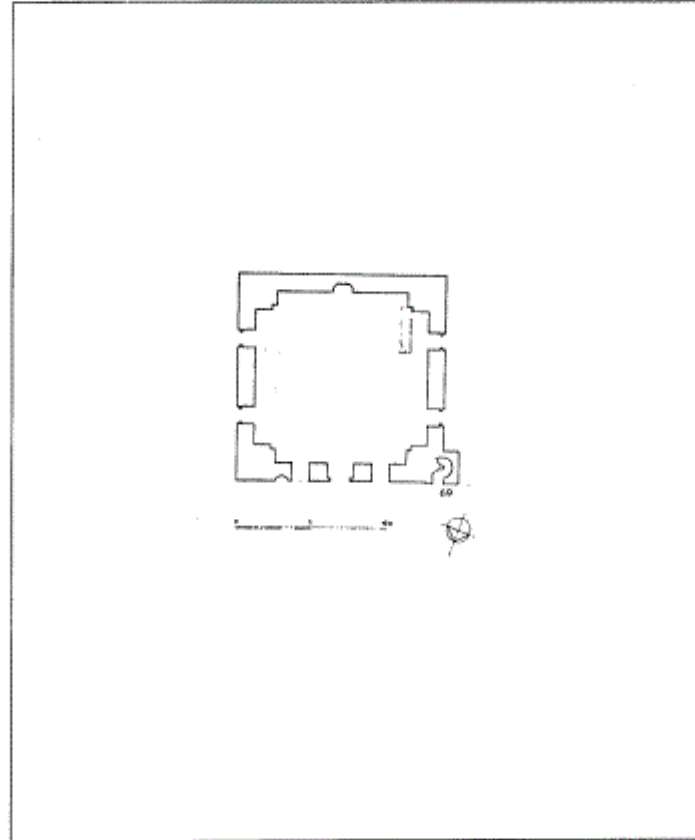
مسقط أفقي لثروة بابزید بلدریم فی بورصة (أوبروسه) (عن : Wilde) .
